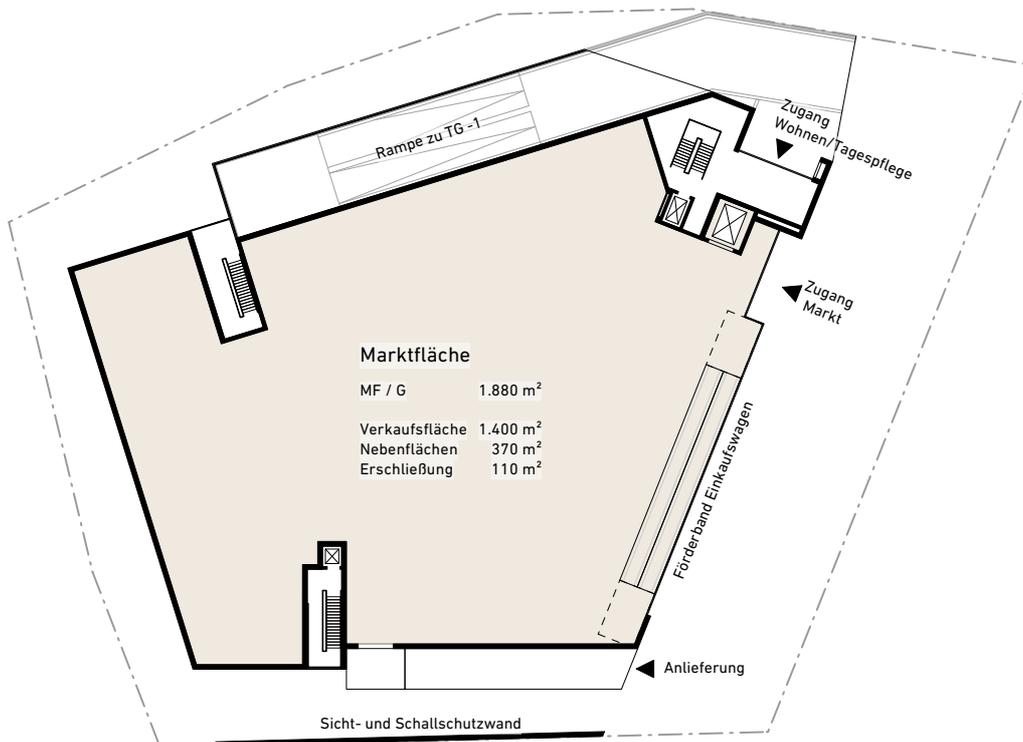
Das Vorhaben - Grundriss 1.Obergeschoss (Vorentwurf)
